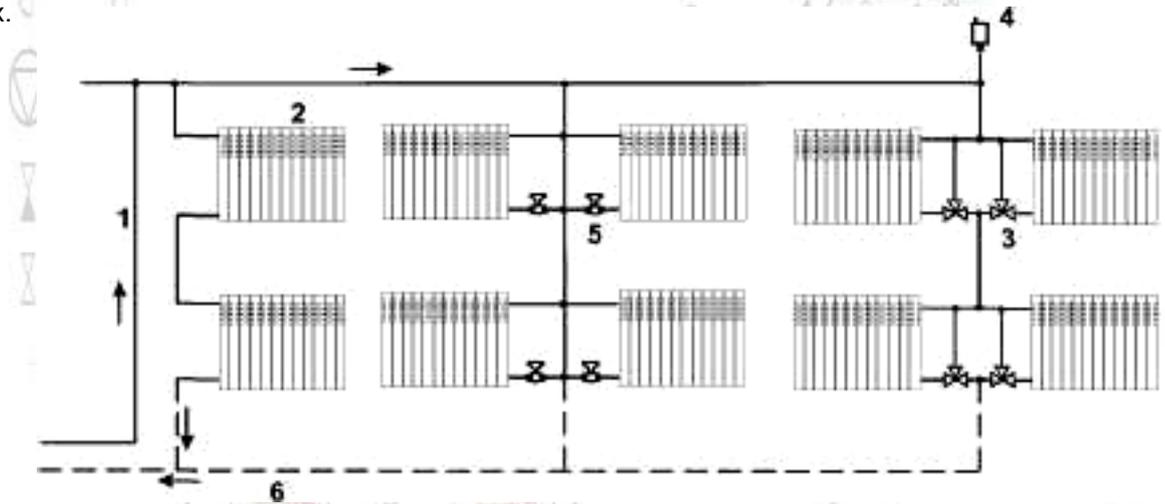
Схема однотрубной системы отопления с верхней разводкой.
